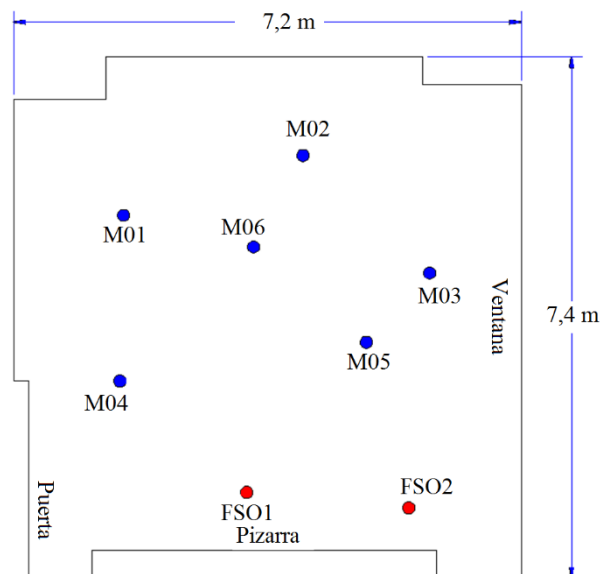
Vista en planta y coordenadas de medición, Aula 154.
